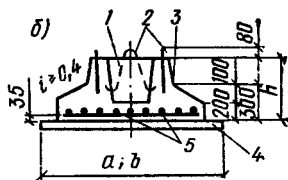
Сборные цельные железобетонные фундаменты колонн
